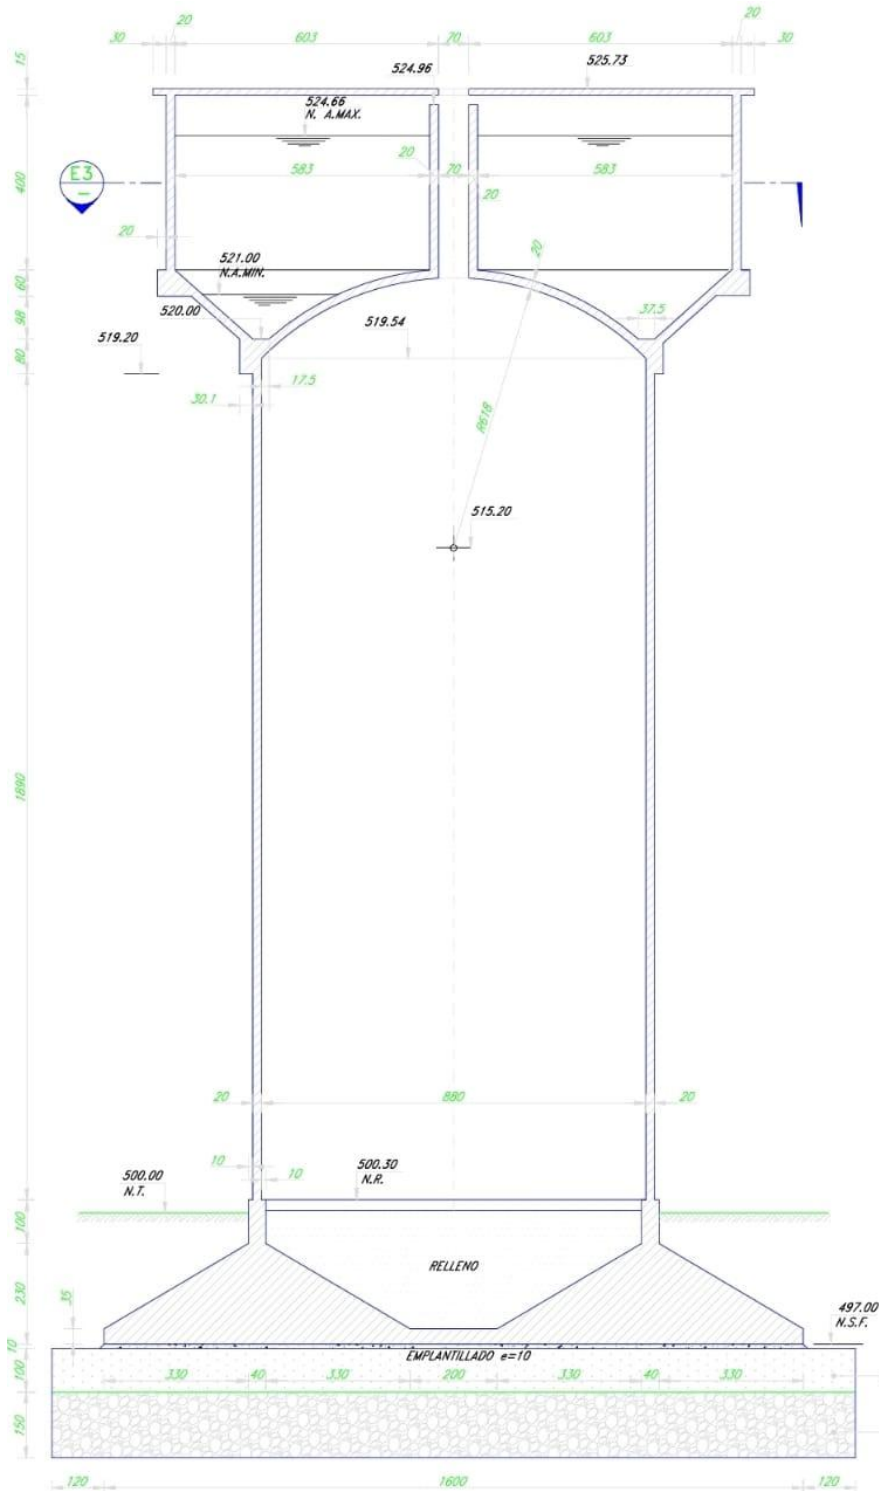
Vista en corte estanque Cartagena. Fuente: Plano de forma proyecto estructural
